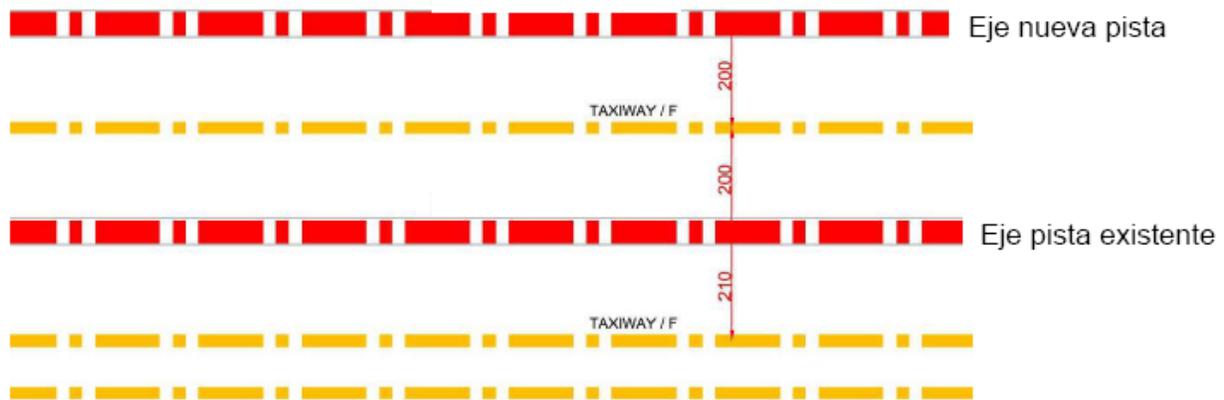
Calles de rodaje proyectadas en el Plan Maestro actual.
